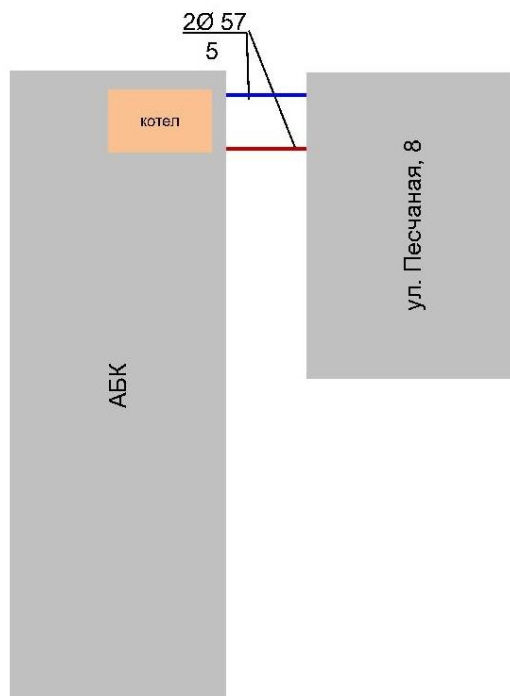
Схема тепловой сети от котельной ул. Песчаная, 8
